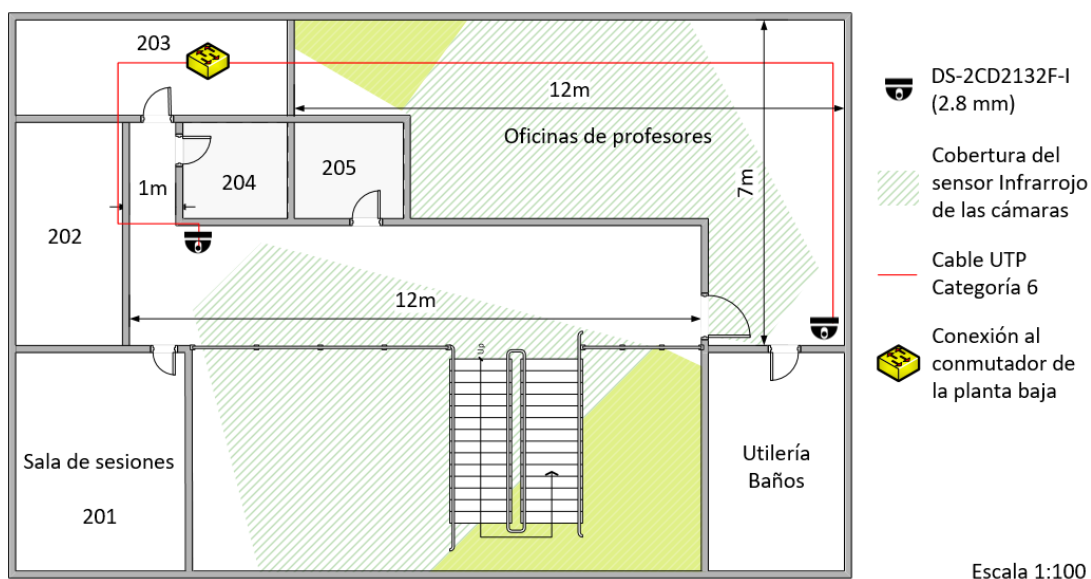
Ubicación de las cámaras en el edificio de Subdecanato 26 AB, planta alta.
